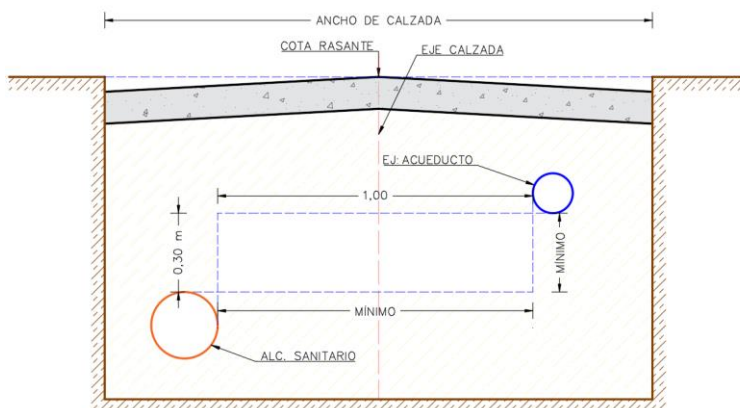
Separación mínima horizontal y vertical colector sanitario con otras redes. Autores del proyecto.
